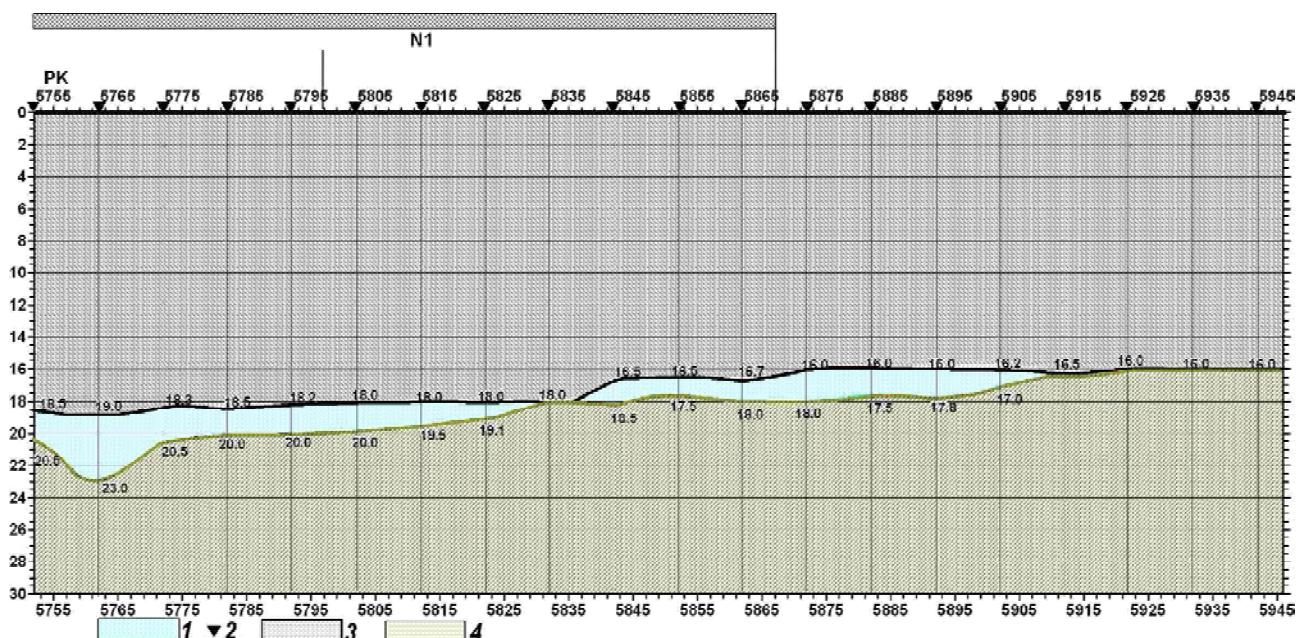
Схема вертикального строения стены в грунте в районе строительства станции метро “Голосеевская” (правая сторона): 1 – зона повышенного увлажнения и повышенной фильтрации грунтовых вод под стеной по состоянию на 20.12.07; 2 – точки ВЭРЗ; 3 – стена в грунте; 4 – суглинки
